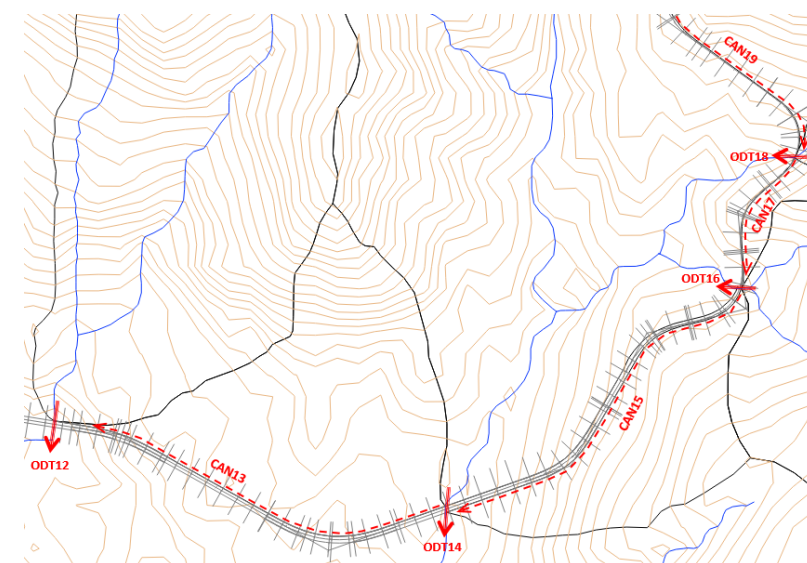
Segundo tramo zona norte. Drenaje longitudinal y transversal. Alternativa 1
